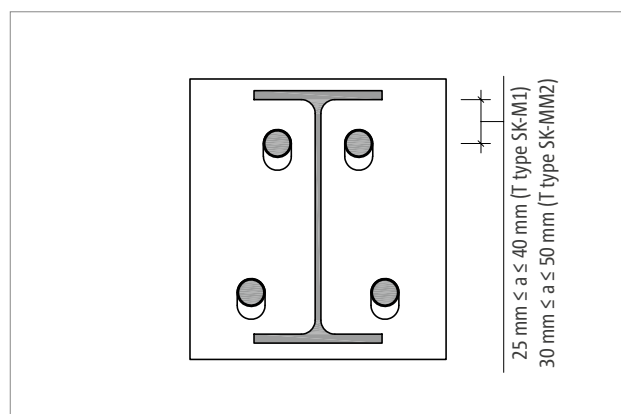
Schöck Isokorb® T type SK-MM2...-H200: raccordement de la platine frontale sur la poutre IPE220
